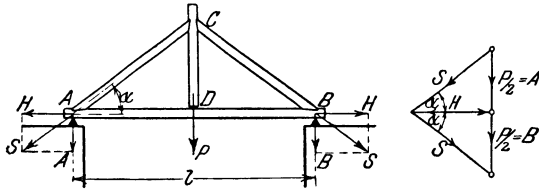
Einfaches Hängwerk. (Aus Gesteschi, Dachkonstr.)
